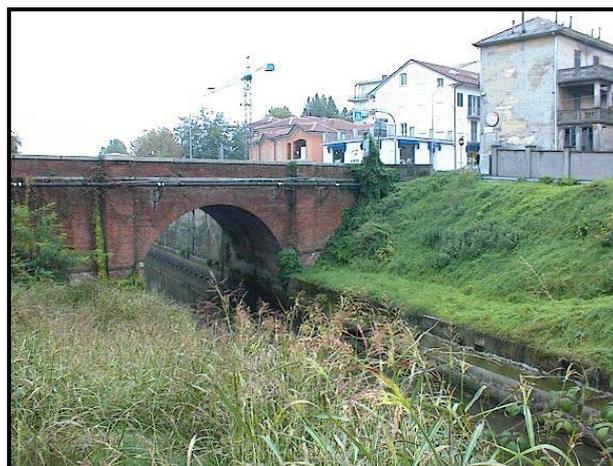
Vista da monte del ponte sulla strada principale lungo il canale Lanza.
